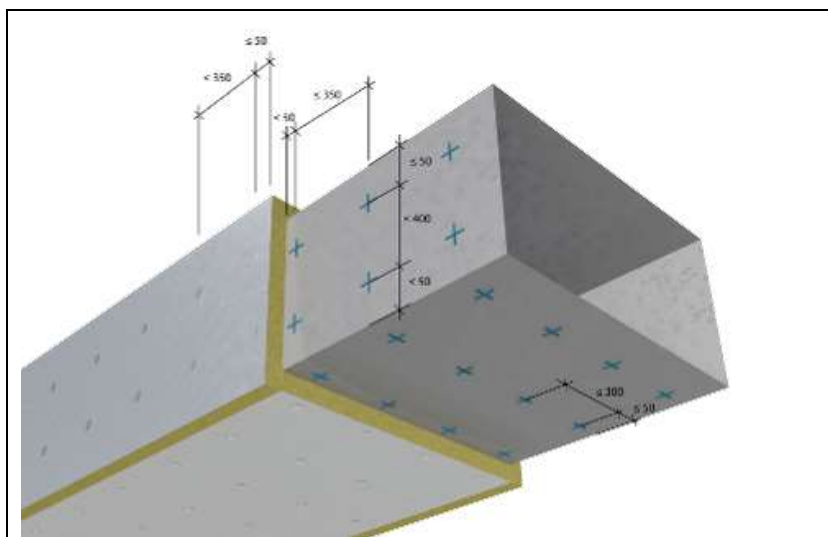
Detalle de la posición de los pins soldados.
